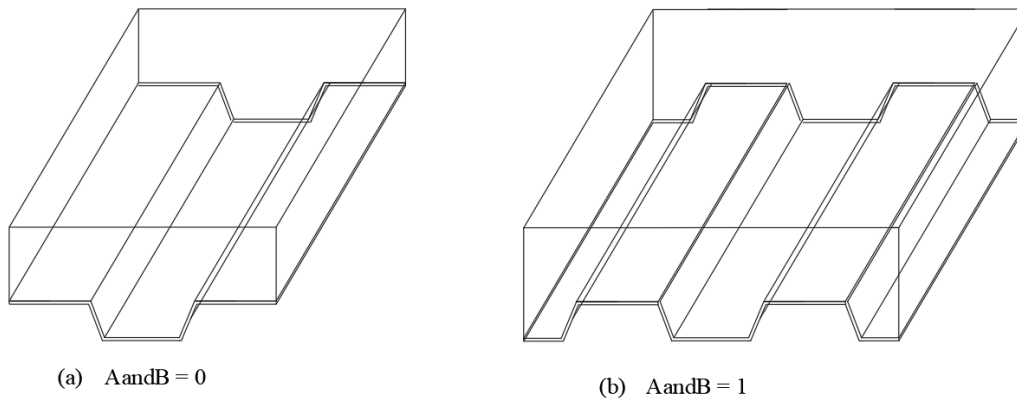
Parâmetros para dimensionamento das nervuras da laje mista MATLAB
